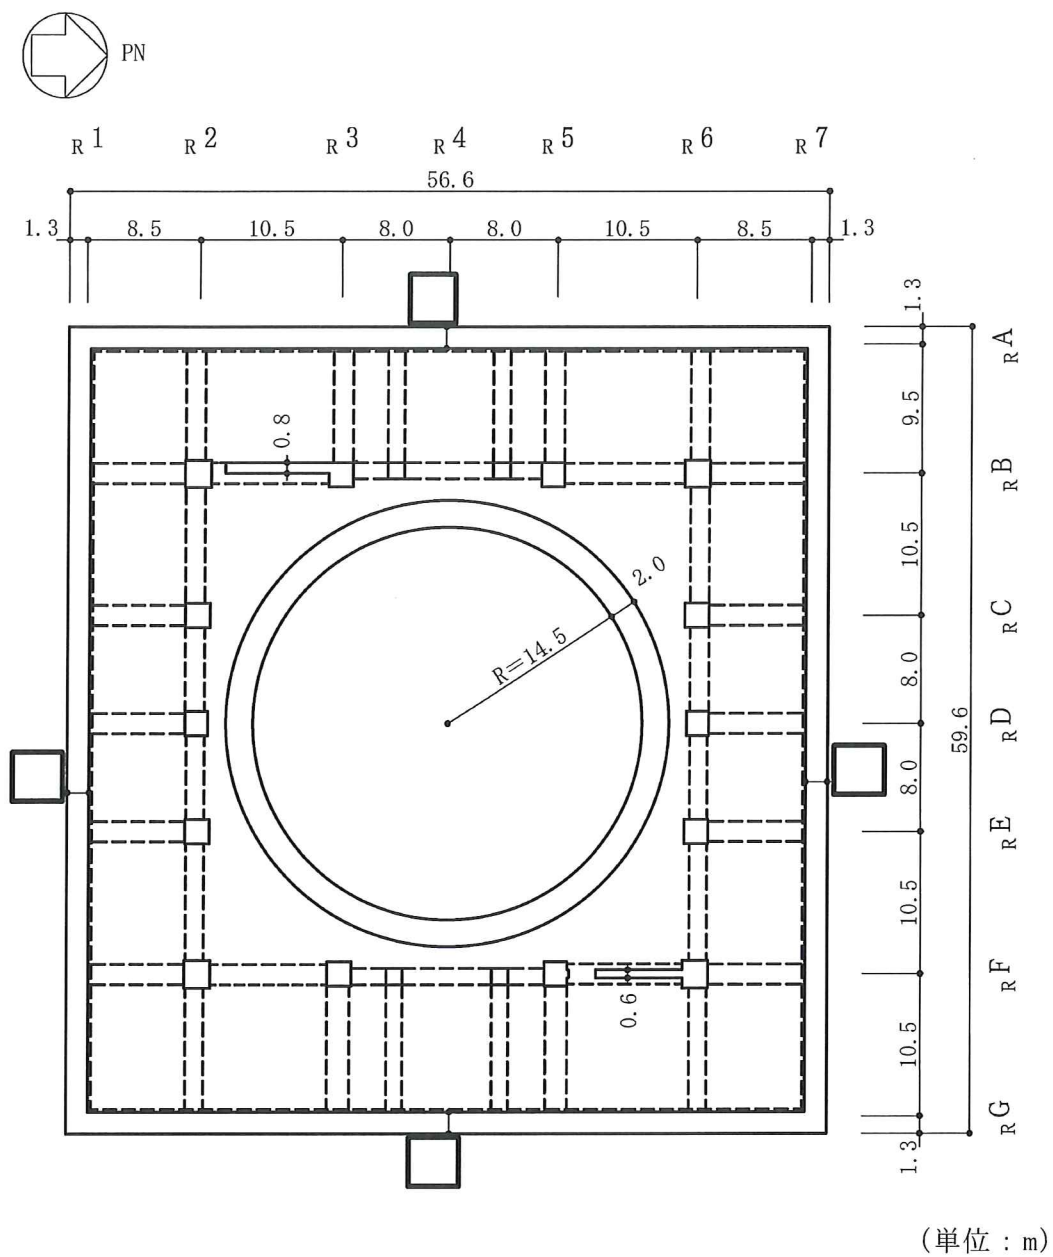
6号機原子炉建屋の概略平面図 (B2F, T. M. S. L. -1.7m) (2/9)
